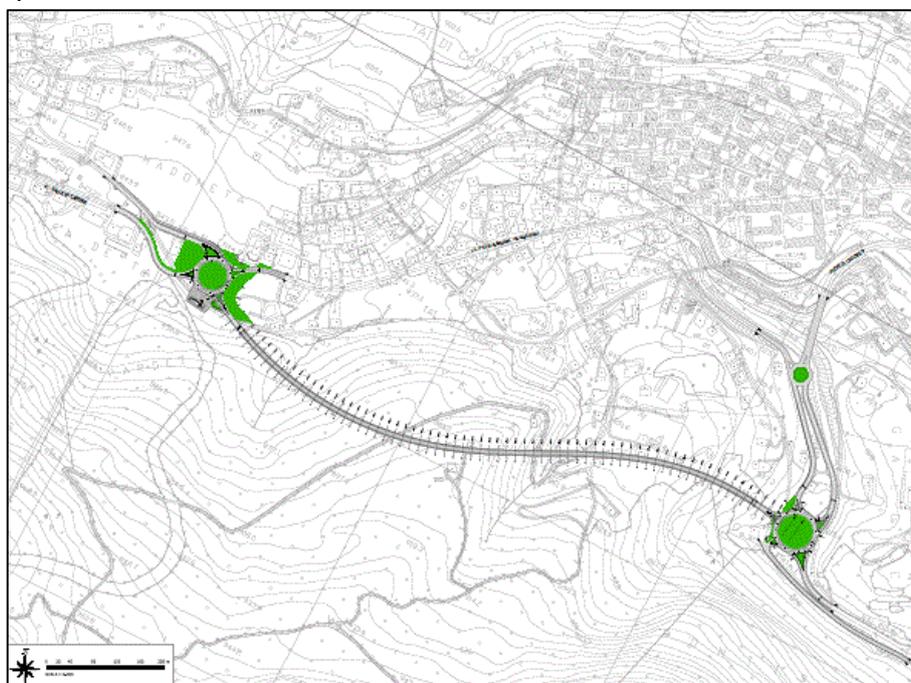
Planimetria del tracciato della variante in progetto (Alternativa 1)
